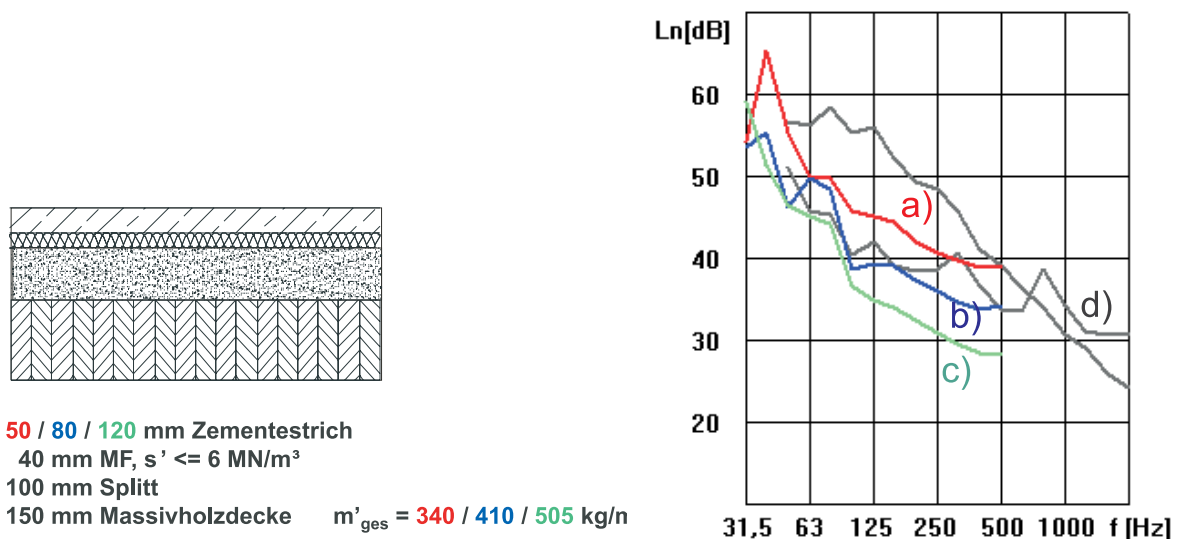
Vergleich unterschiedlicher Estrichstärken: a) Berechnung mit 50 mm Zementestrich b) Berechnung mit 80 mm Zementestrich c) Berechnung mit 120 mm Zementestrich d) Messwerte für Zementestrichaufbau auf einer 160 mm Stahlbetondecke
